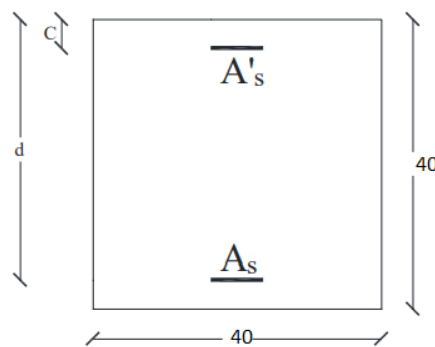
coupe d'un poteau de dimensions (40x40) cm
